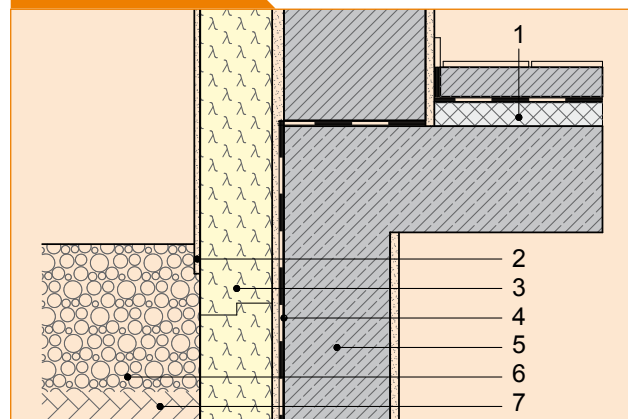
Polyurethan-Dämmung der Kelleraußenwand.
